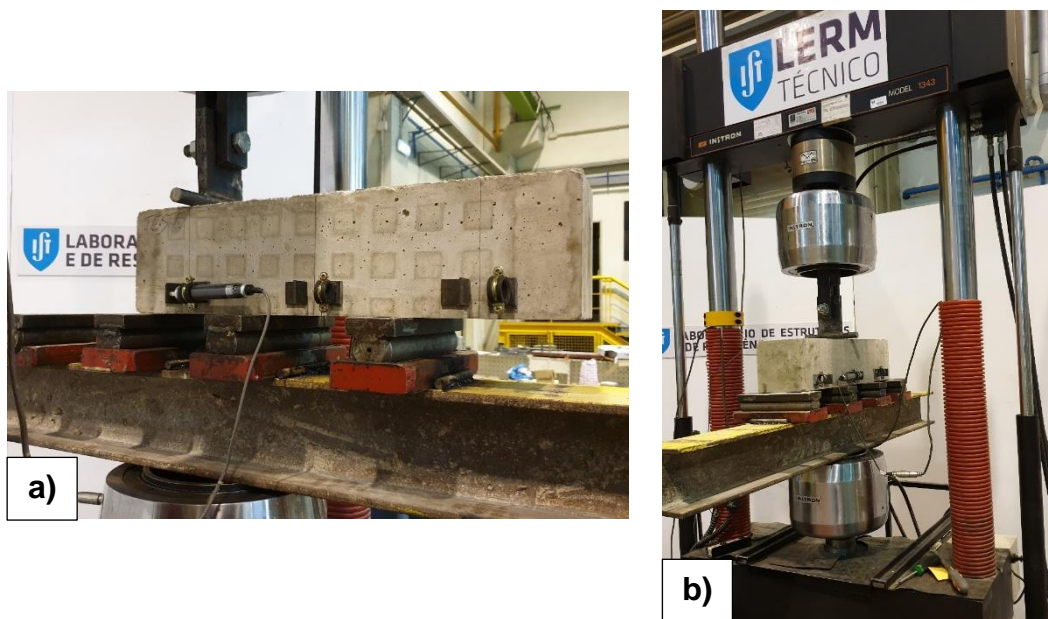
Ensaio de flexão: a) Viga a ser ensaiada; b) Prensa hidráulica INSTRON
